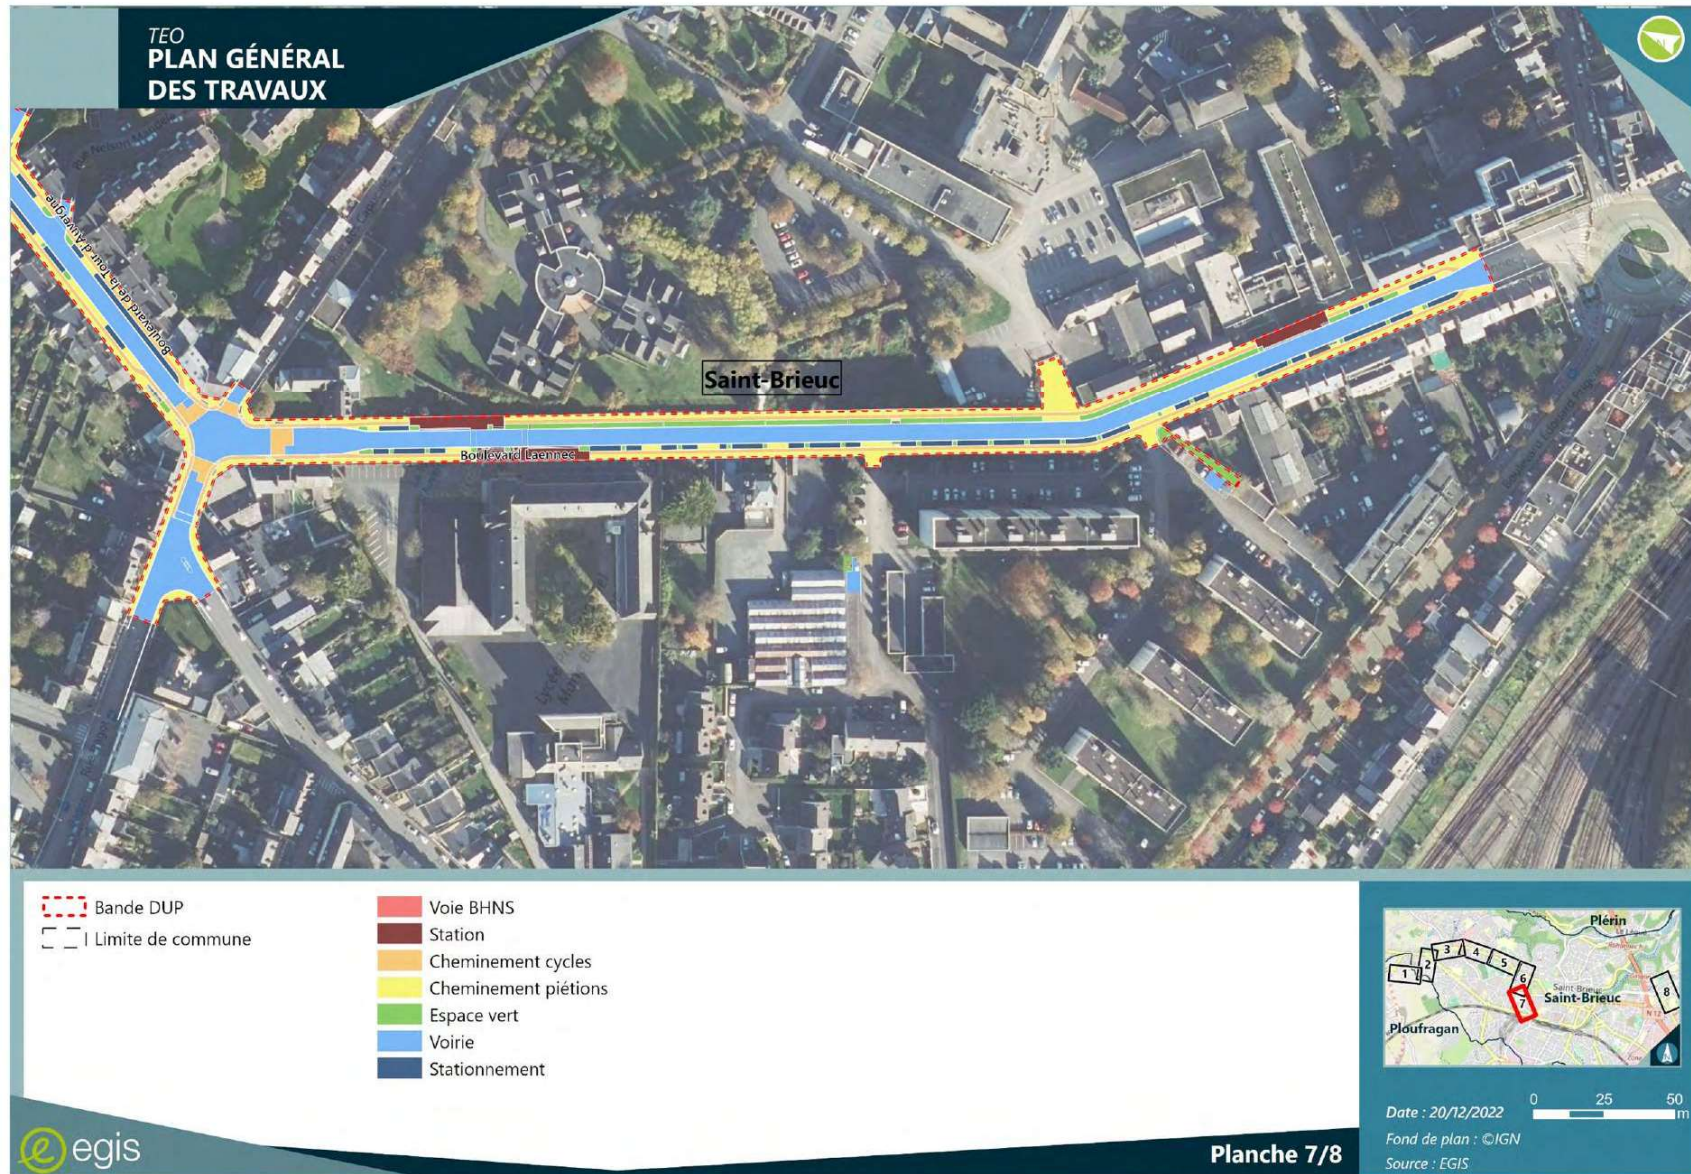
Plan général des travaux 7/8 (Source : EGIS)
